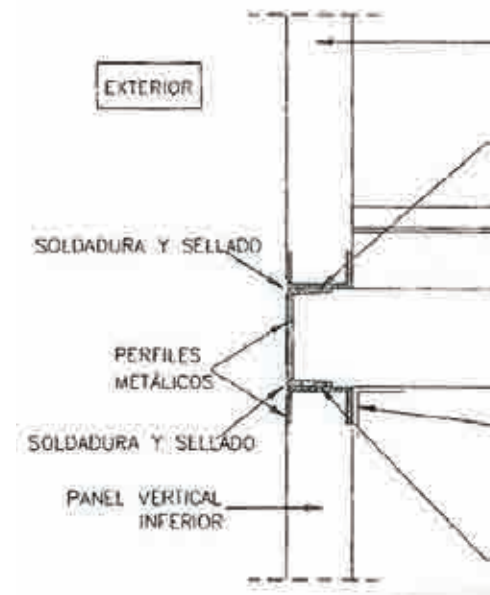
Unión de paneles exteriores estructurales con forjado. Sistema *PANELMARK* de *Leiro
